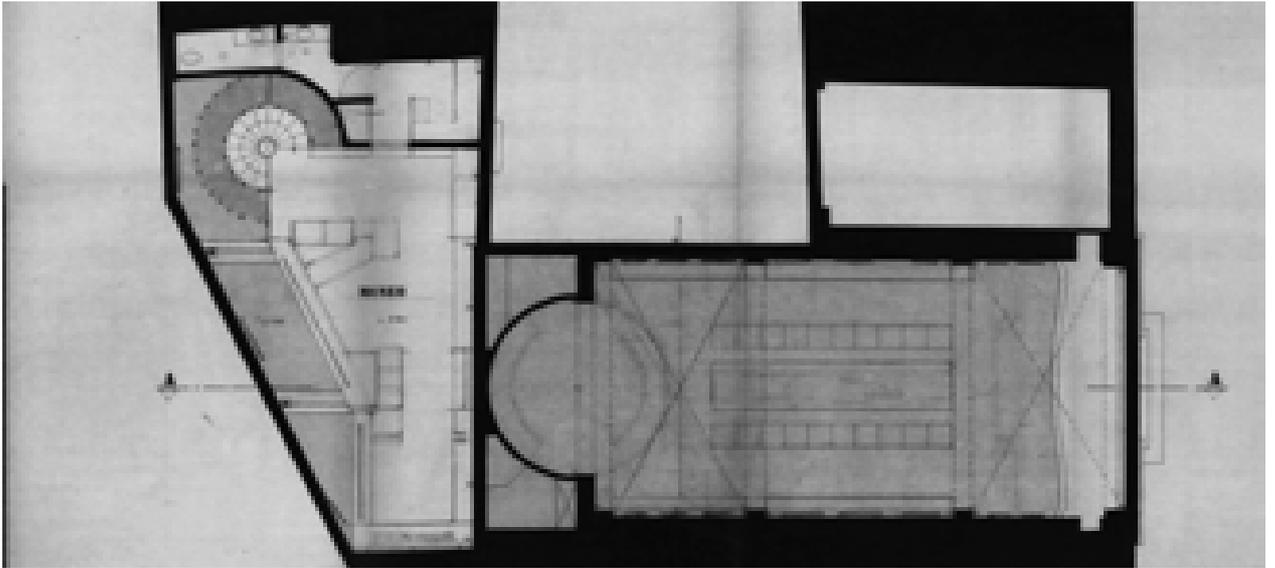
Pianta doppio volume – Stato di progetto – 10/11/1980 (AABS-94.051)
